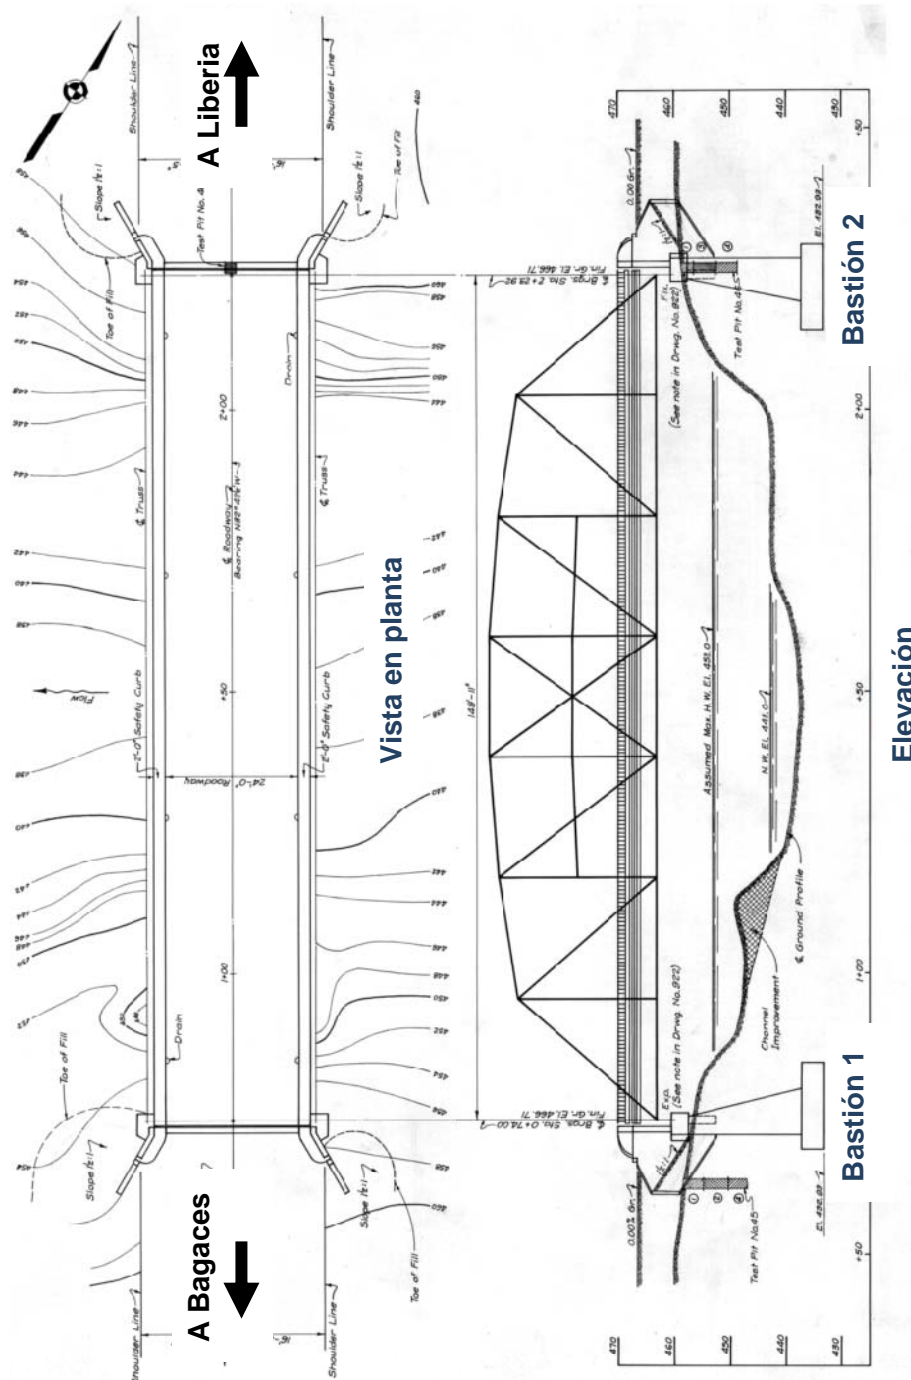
Vista en planta y en elevación en planos estructurales y nomenclatura utilizada para la identificación de los distintos componentes del puente sobre el río Liberia.
